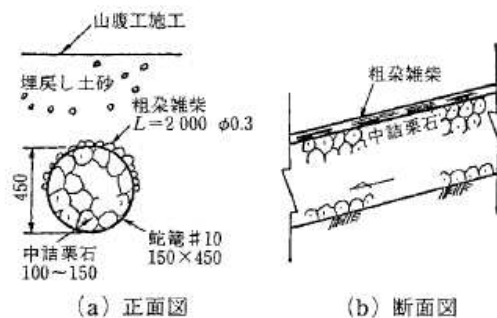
蛇籠暗渠工の例(単位: mm)
